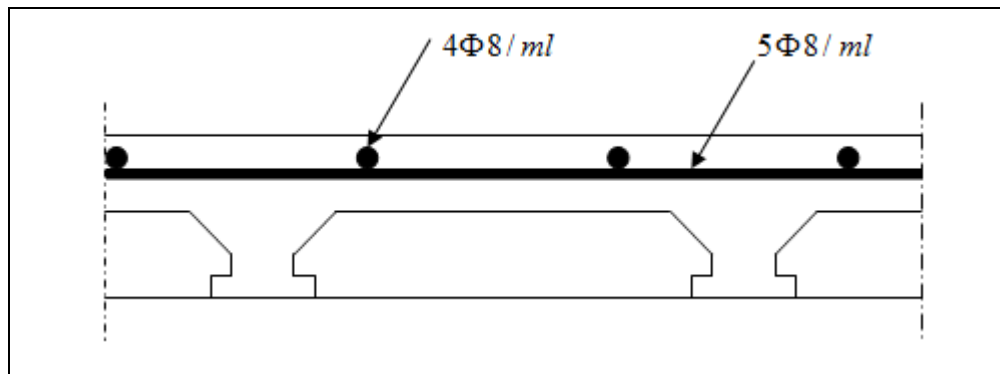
Schéma de ferrailage de la dalle de compression.
